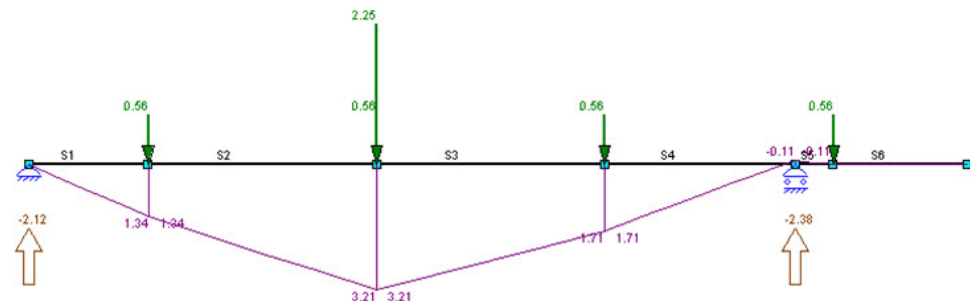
geometrie van de brugconstructie en belasting door het plafondsysteem
